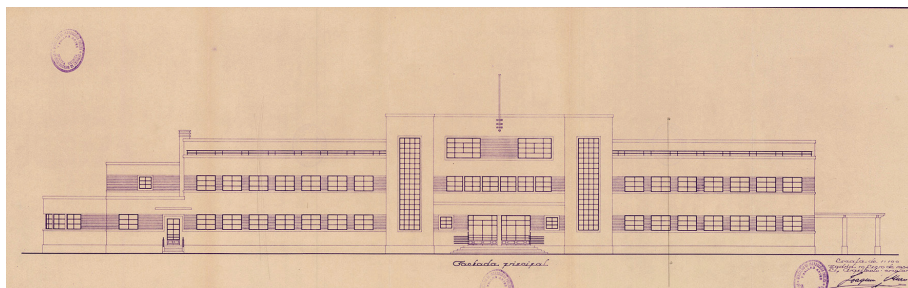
Fachada principal del proyecto de escuela graduada en Medina de Rioseco (Valladolid, 1934) del arquitecto Joaquín Muro (Fuente: AGA, Educación, 32-414).
